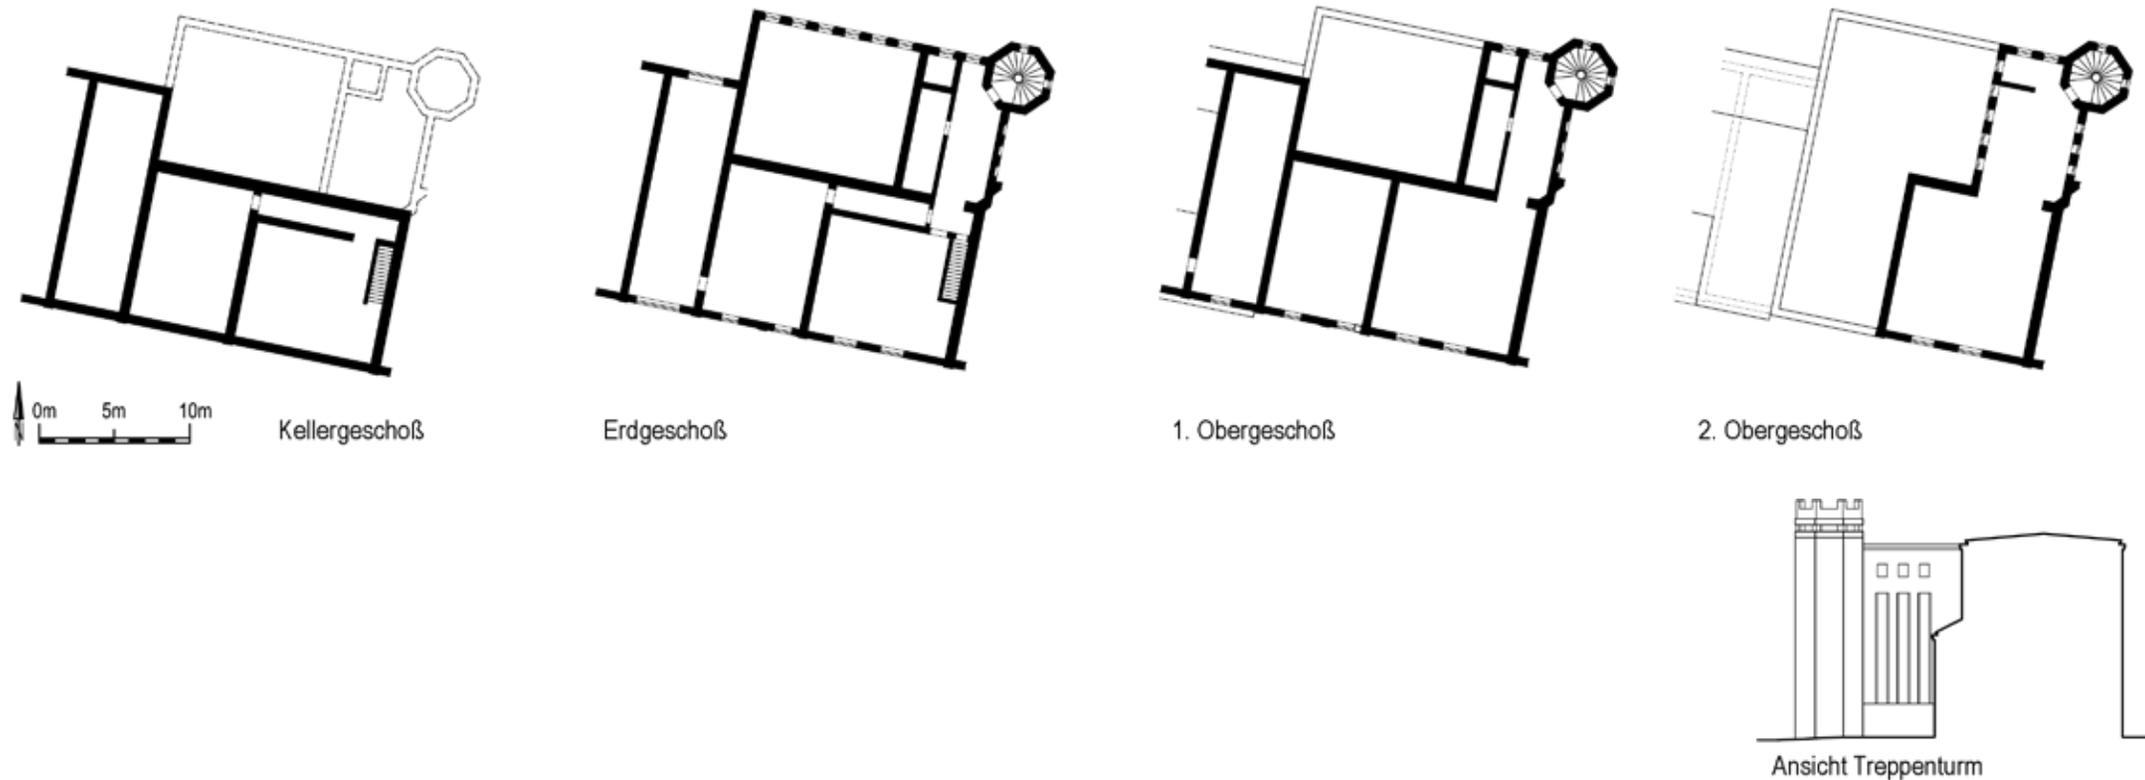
Grundriss- und Schnittdarstellung des Bürogebäudes/Kondor und Sudhauses, M1:500
